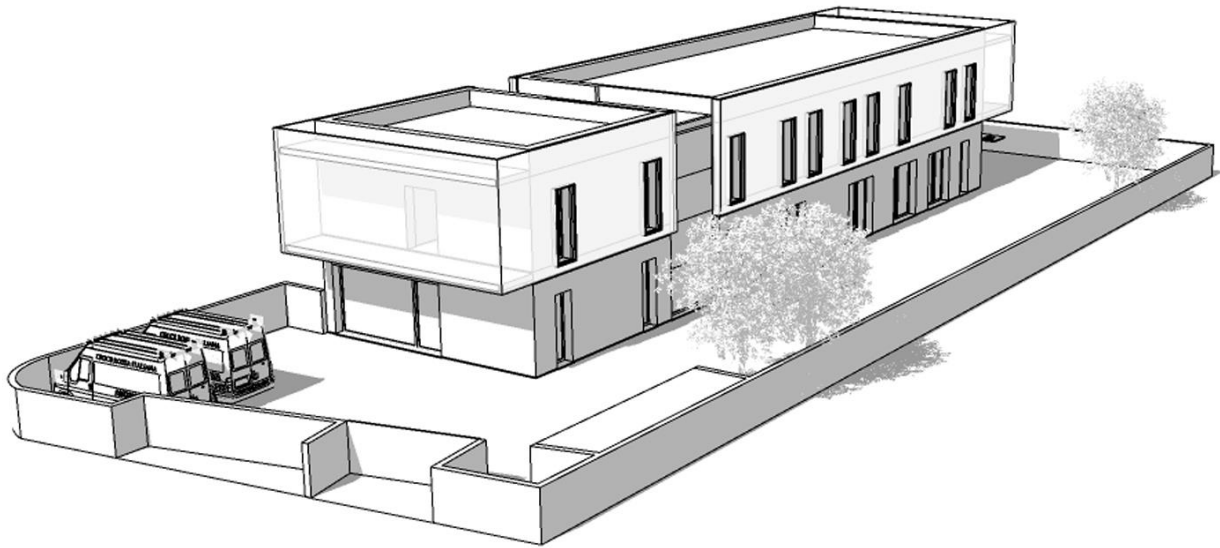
schizzo di progetto preliminare Nuova Sede Croce Rossa di Pontasserchio vista sud-est
